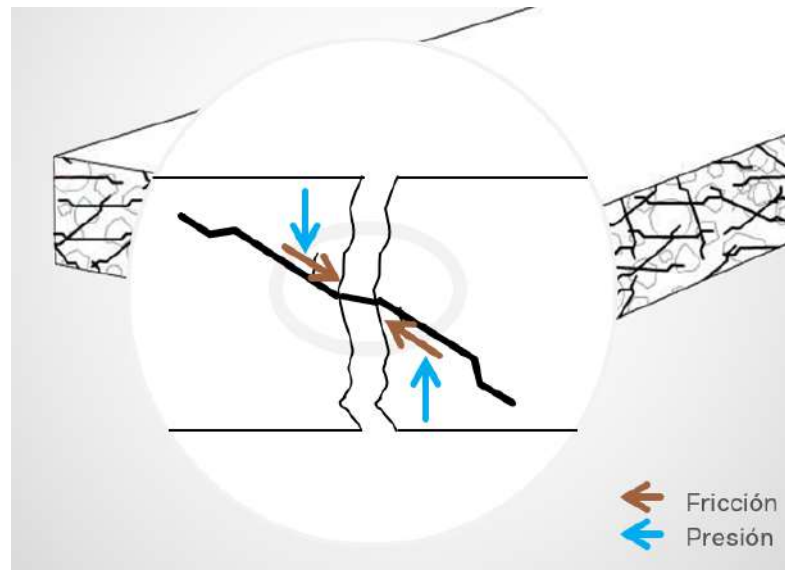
Fibras de acero que forman puentes entre grietas
